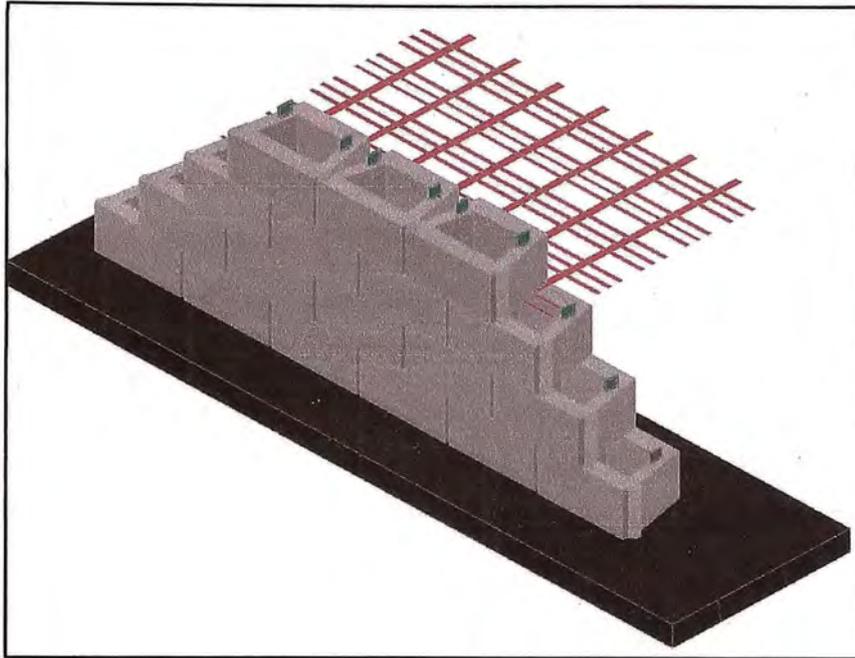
Muro de suelo reforzado – Detalle de colocación de Geomalla Mac-Grid.
